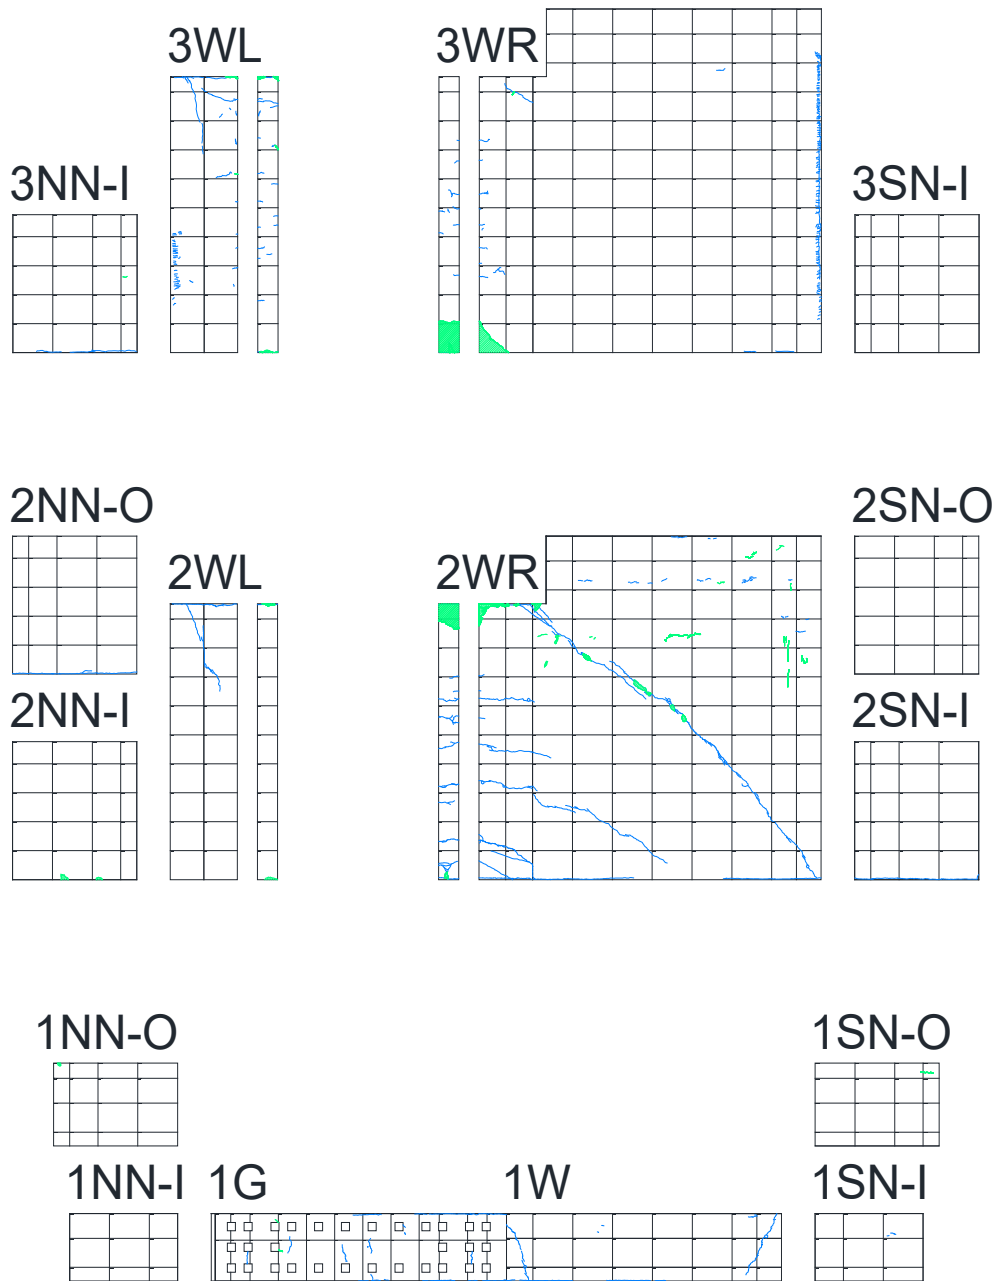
耐力壁および直交壁のひび割れ推移 サイクル:1/400 ①
